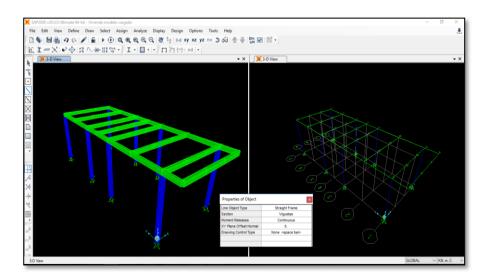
Trazado de elementos tipo vigas para modelación.
